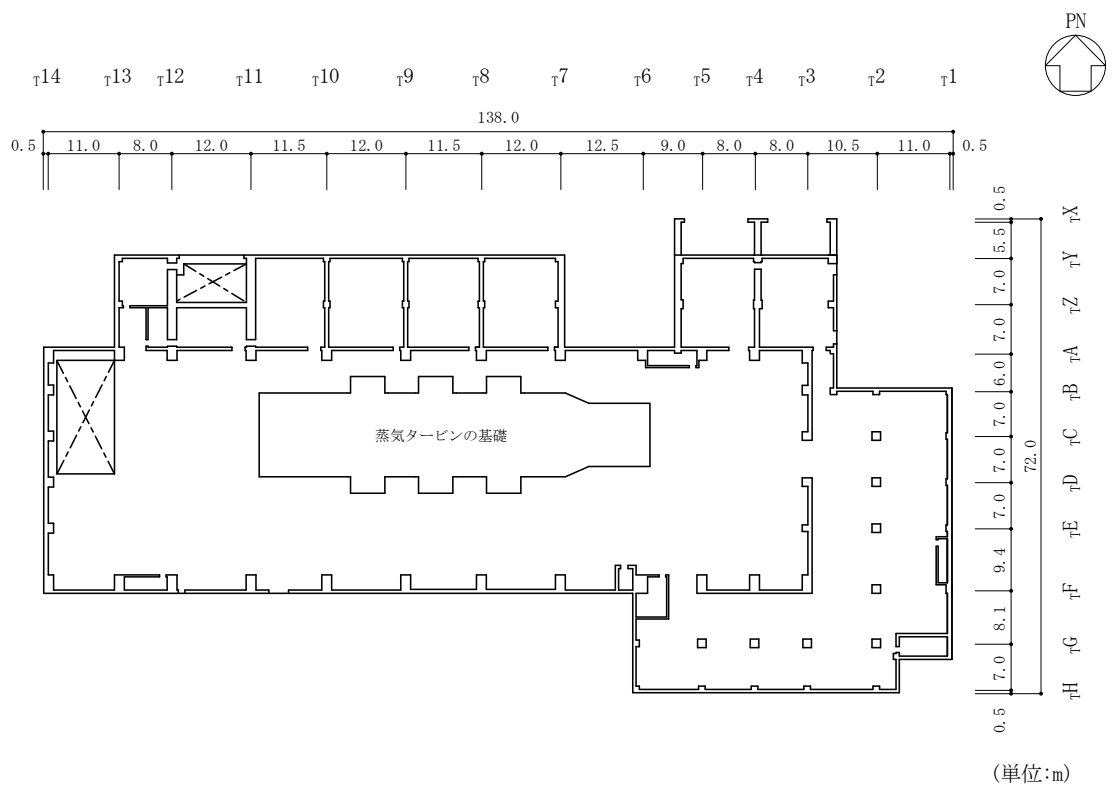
(4) タービン建物の概略平面図 (EL 20.6m)
